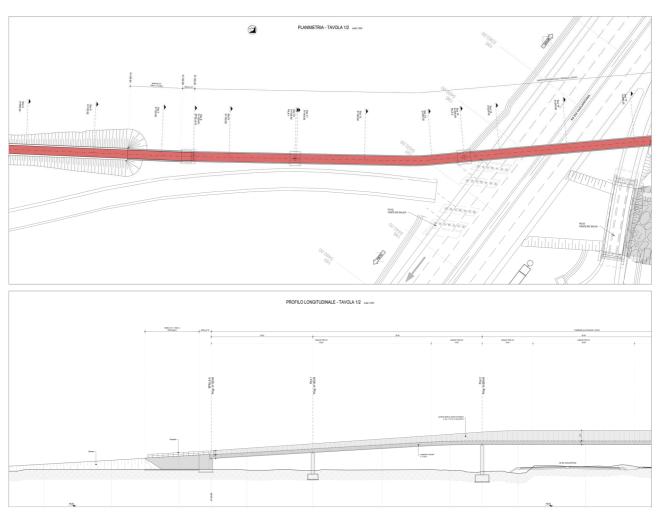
Pianta e prospetto del ponte (1 di 2)
